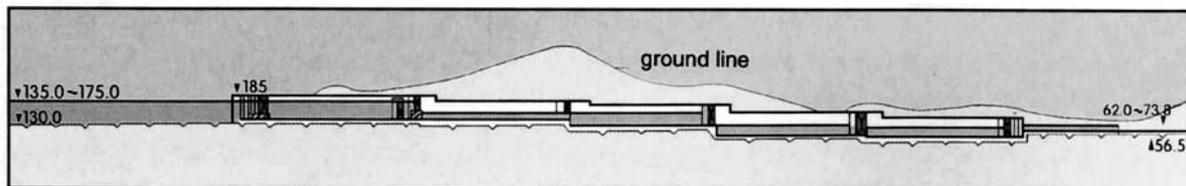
Längsschnitt durch die Schleusenkette des Drei-Schluchten-Damms
